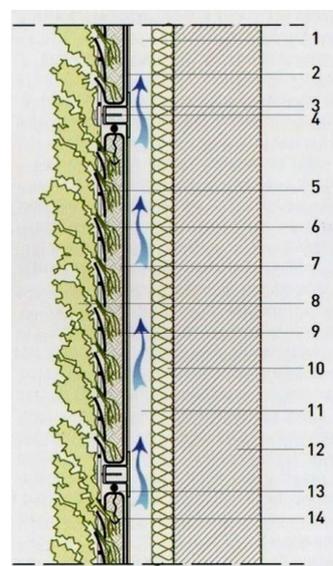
Corte explicativo de uma fachada viva tipo muro-cortina:
